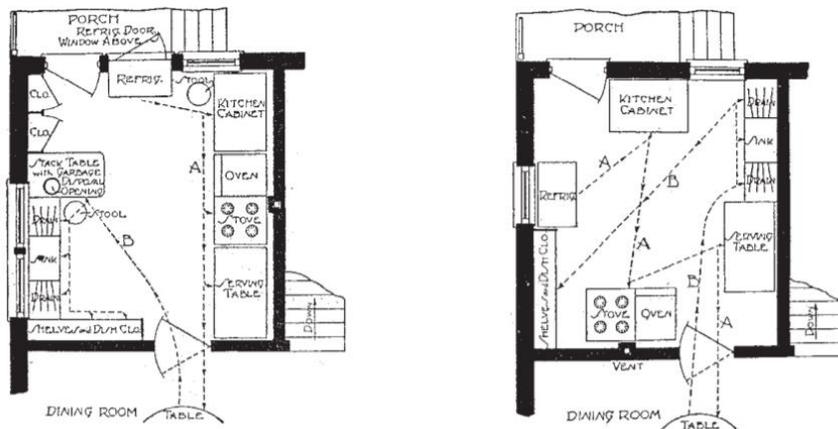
Planta cocina The new housekeeping, 1913. Fuente: Ciudad sin cocina. Puigjaner, 2014.
